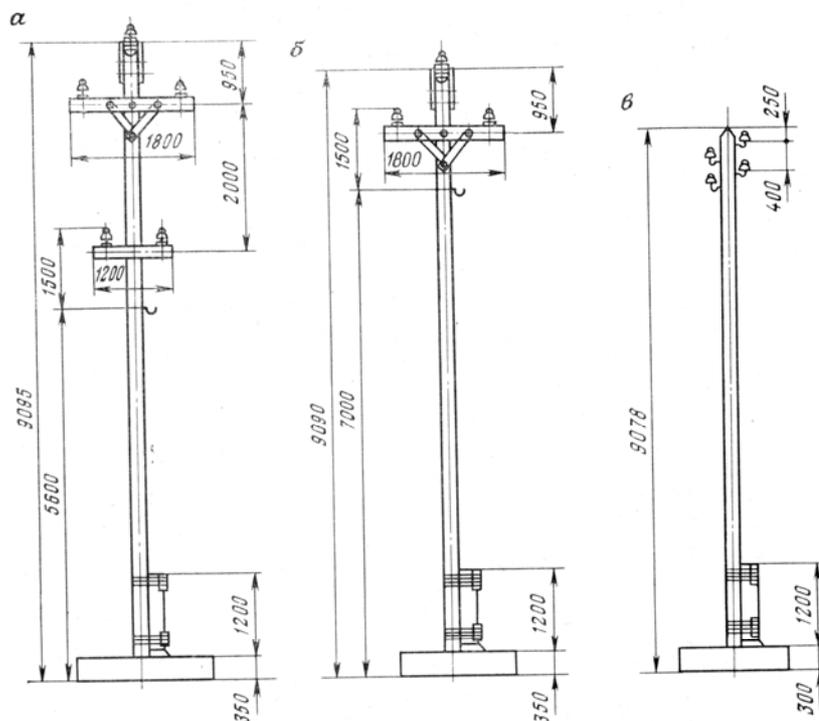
Деревянные промежуточные опоры на железобетонных основаниях для передвижных ВЛ 0,22–10 кВ: *а* – для проводов ВЛ 6 кВ, осветительной линии 0,22 кВ и магистрального заземляющего провода; *б* – для проводов ВЛ 6 кВ и магистрального заземляющего провода; *в* – для проводов осветительной линии 0,22 кВ.
